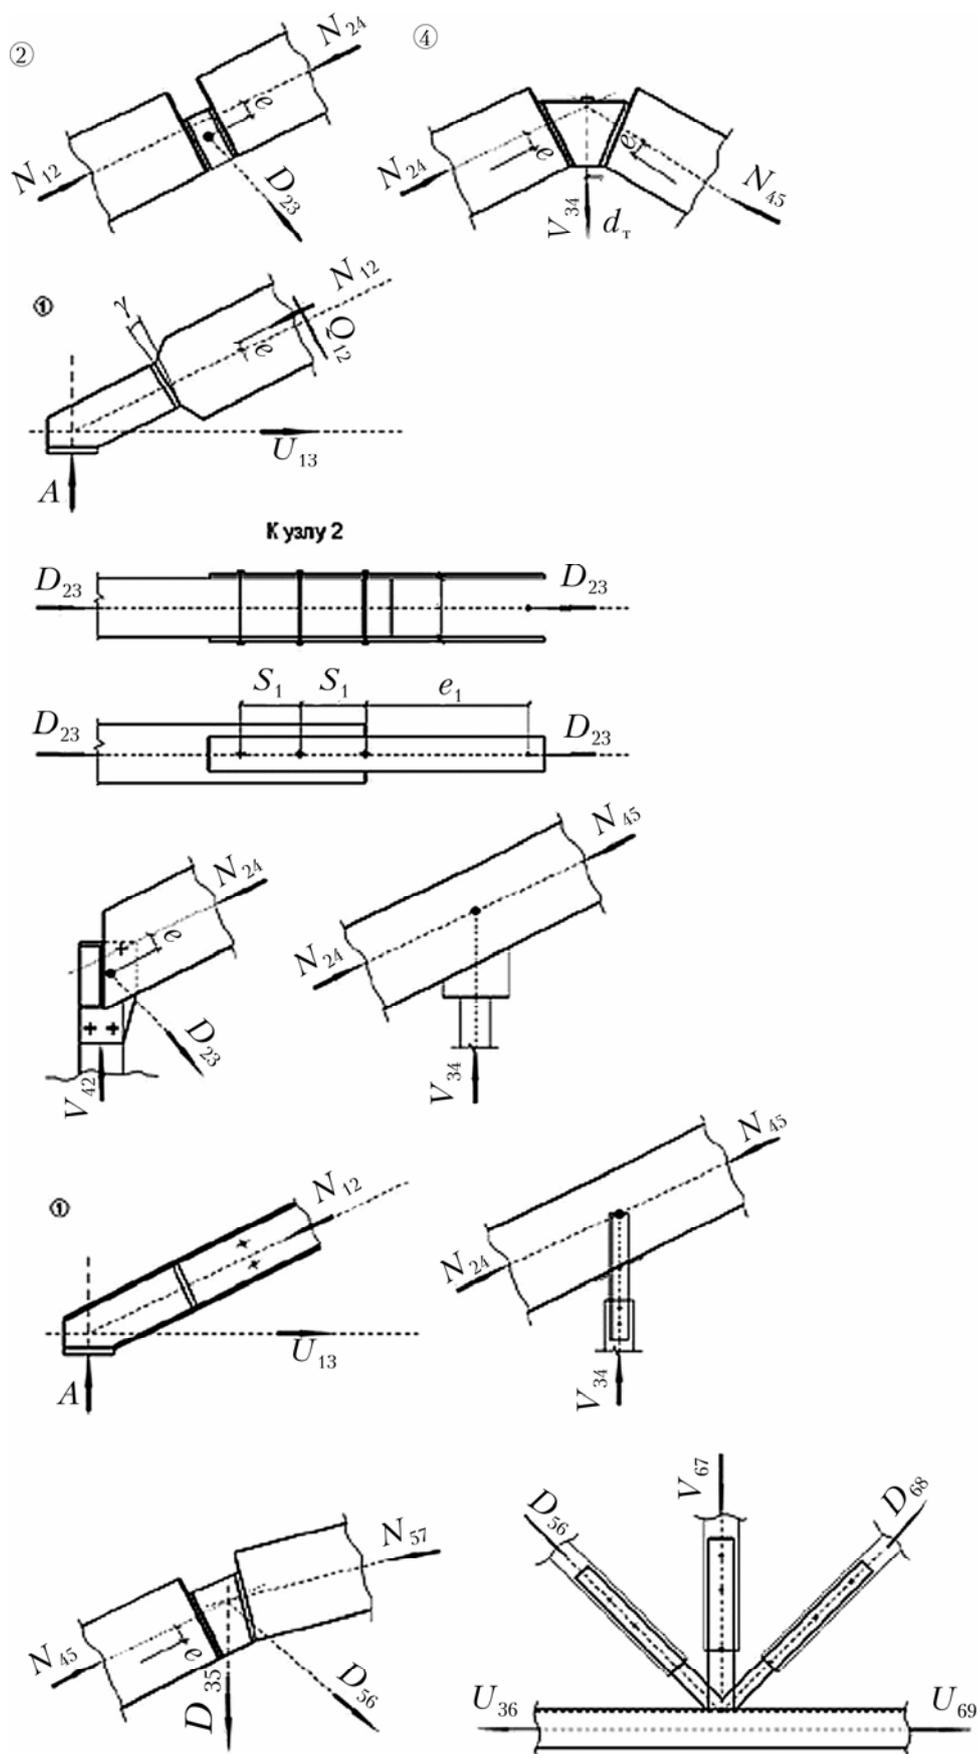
Конструктивные схемы узлов и деталей ферм (начало)
